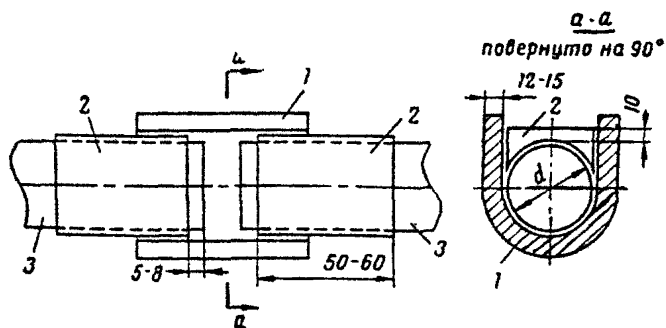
Схема сборки медной желобчатой скобы-подкладки I и медных вкладышей-ограничителей плавильного пространства 2 при подготовке к ванно сварке стержней 3
